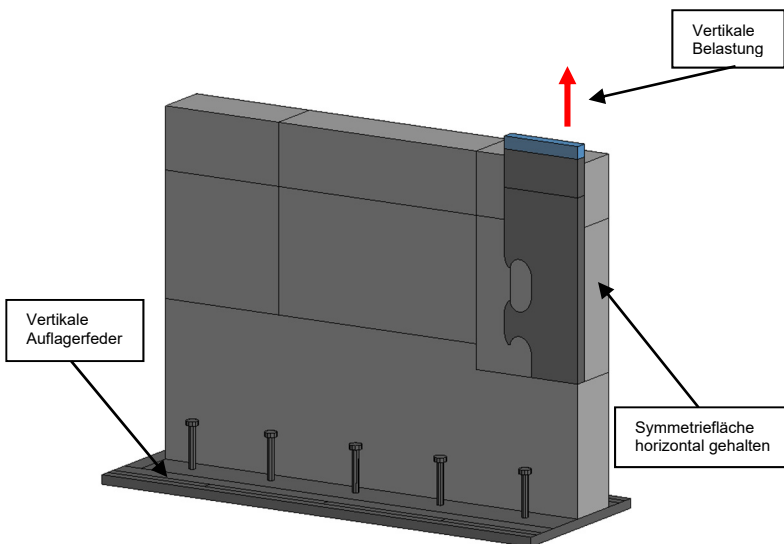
Lagerbedingungen und Belastung des nichtlineares FE-Modell des Zugversuches Versuchsreihe 5 in der Pre-Processing Darstellung von GiD (dunkel-grau: Stahleinbauteil und Grundplatte mit Kopfbolzen; hell-grau: hintere Betonhälfte; blau: Lasteinleitung; vordere Betonhälfte und Bewehrung wurden ausgeblendet)
